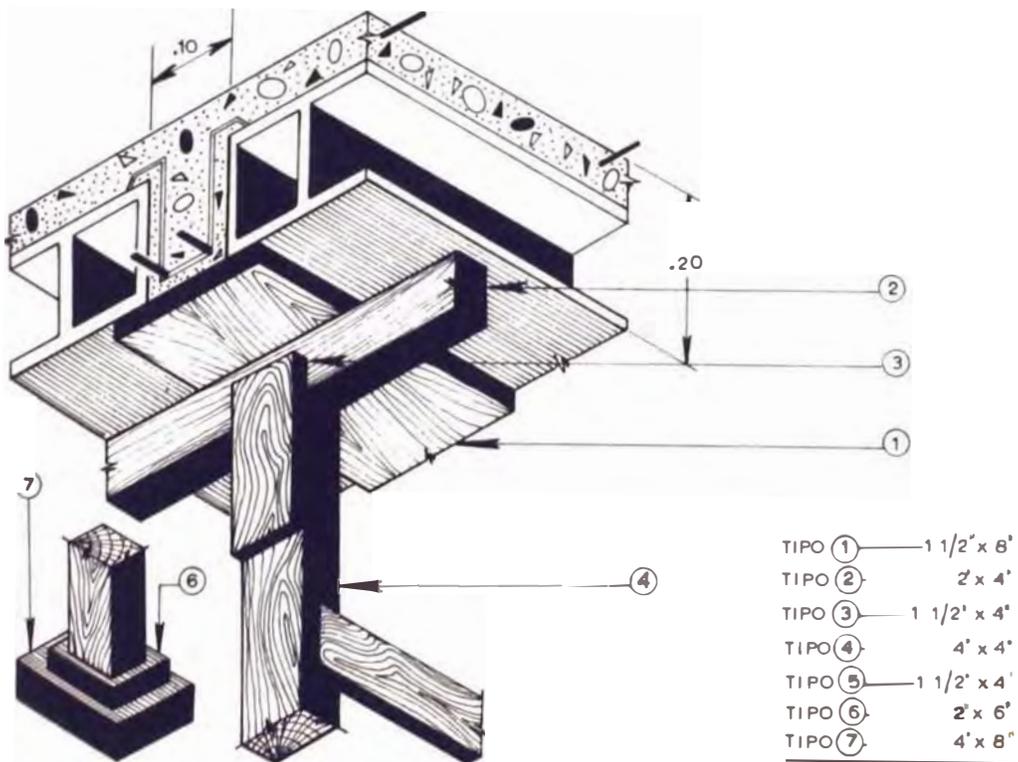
ENCOFRADO DE TECHO ALIGERADO
